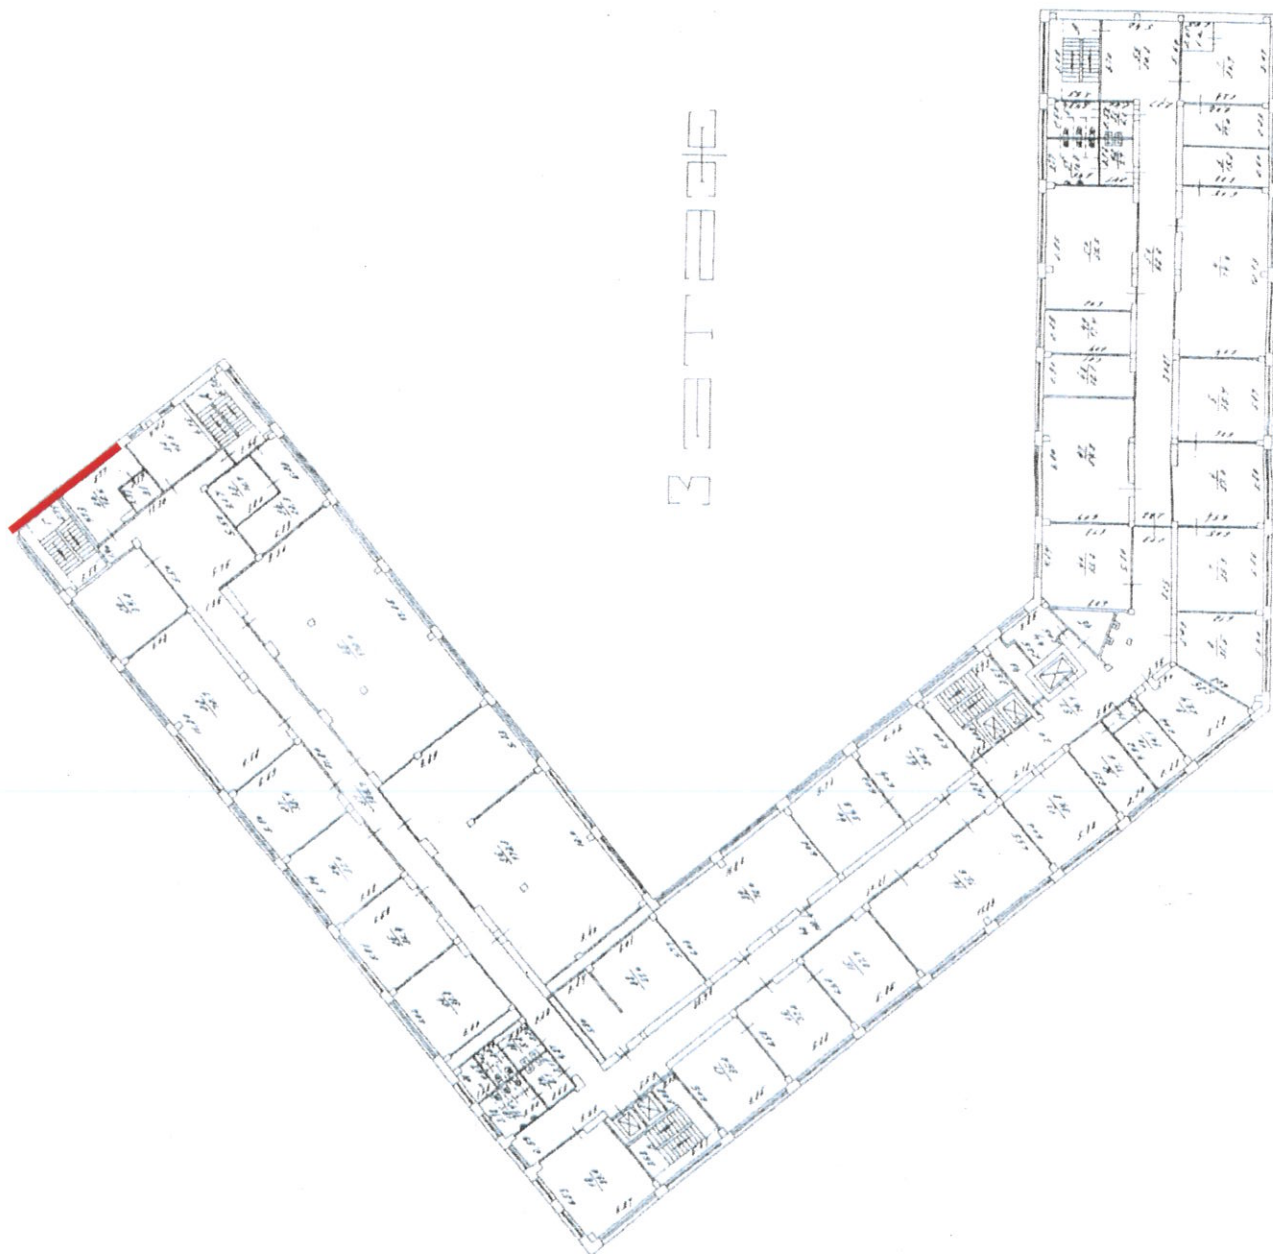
Схема расположения поврежденных строительных конструкций на уровне третьего этажа здания
